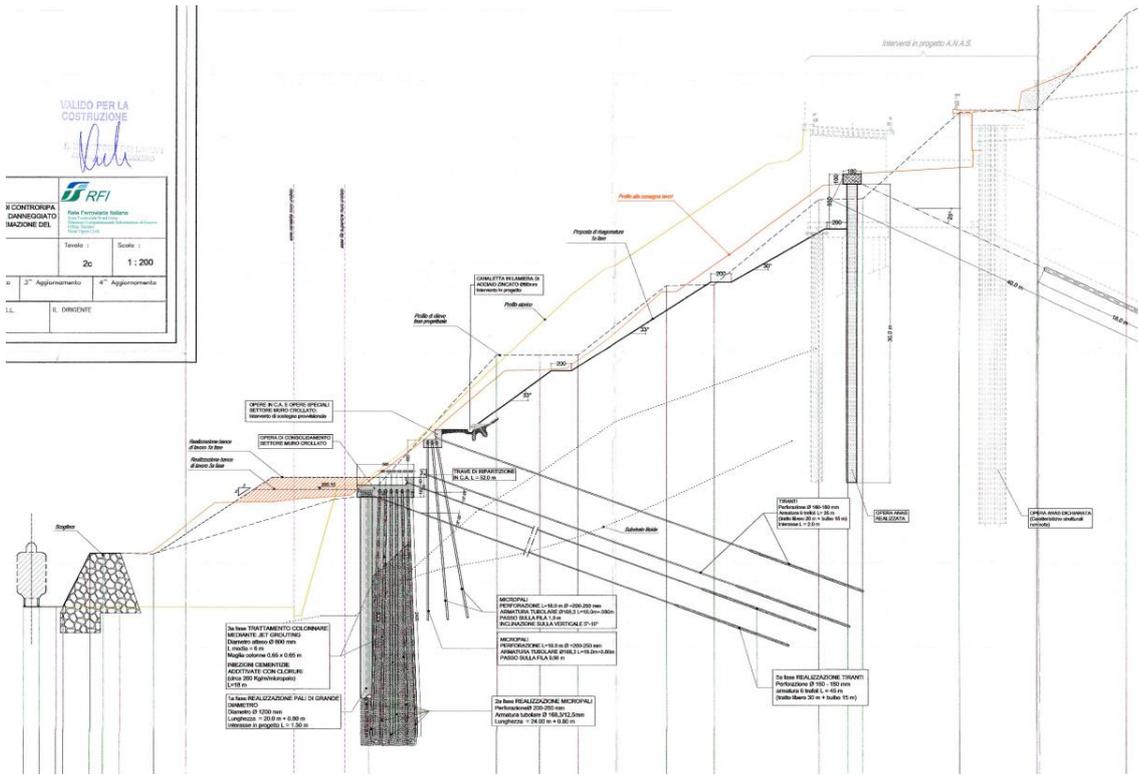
Stralcio di una delle sezioni di progetto 2003 per il tratto di muro crollato.
